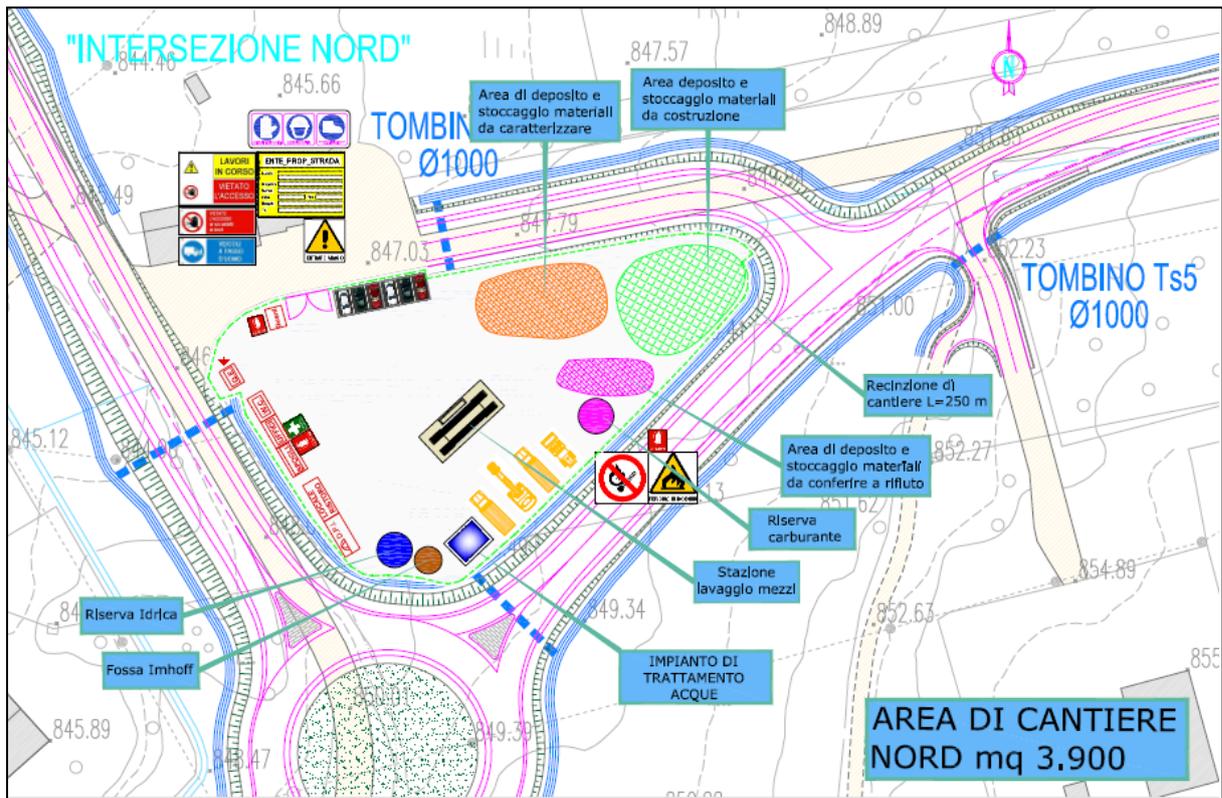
Ubicazione dei siti di deposito temporaneo su stralcio planimetria di progetto.
